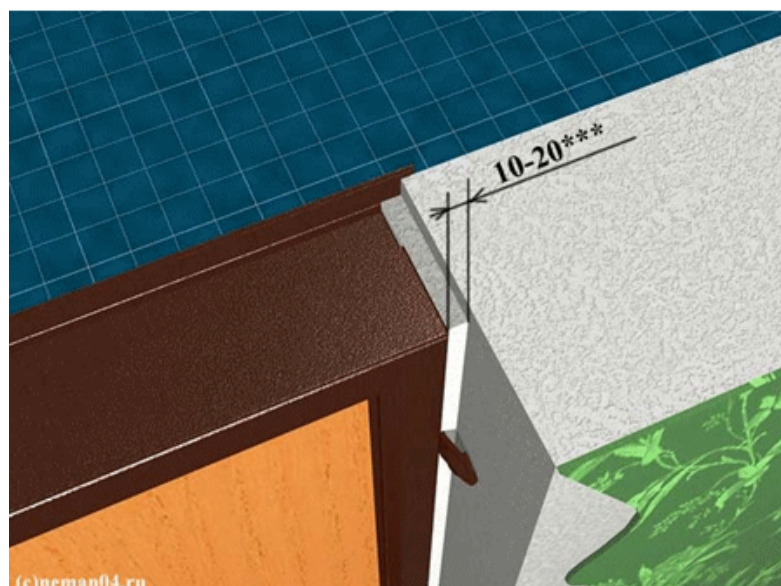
Схема установки металлической двери в проем железобетонной стены по типу Б-1
